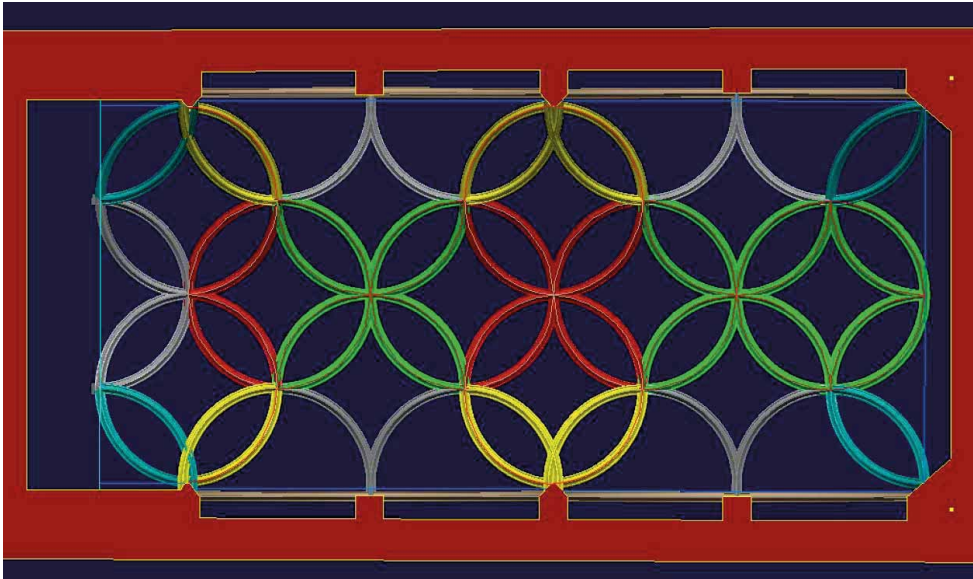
© 2011 Bauer-Lauterbach – Nachkonstruktion Rippen Landhauskapelle nach eigener Vermessung – Figuration Untersicht
